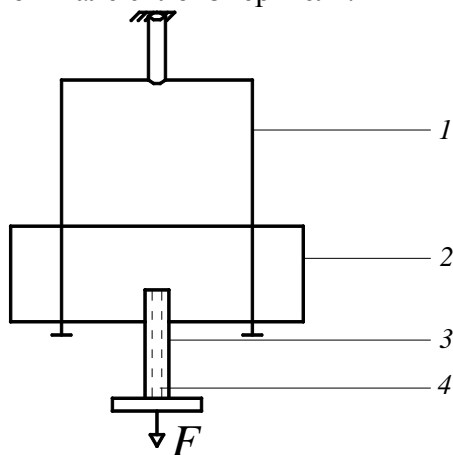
Схема испытаний усилия вырыва дюбелей из основания:
